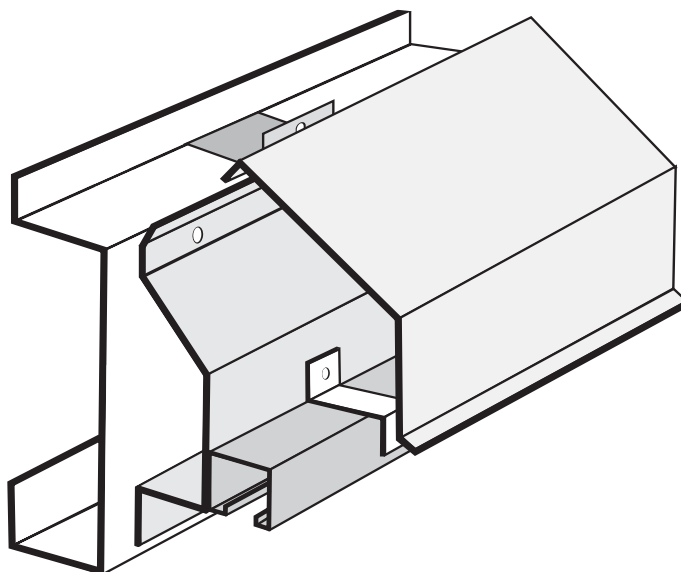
INSTALLATION DE LA PORTE COULISSANTE
